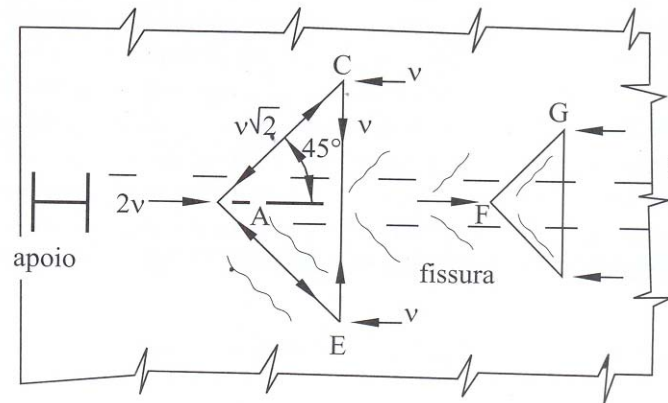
27– Modelo de treliça para armadura transversal –
